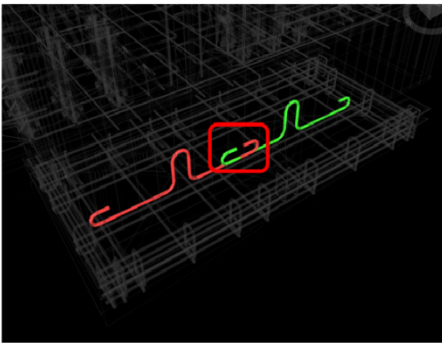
~17F PCB14L, PCB15L 详图	位置	B户型预制件	等级	简单	中等	严重
